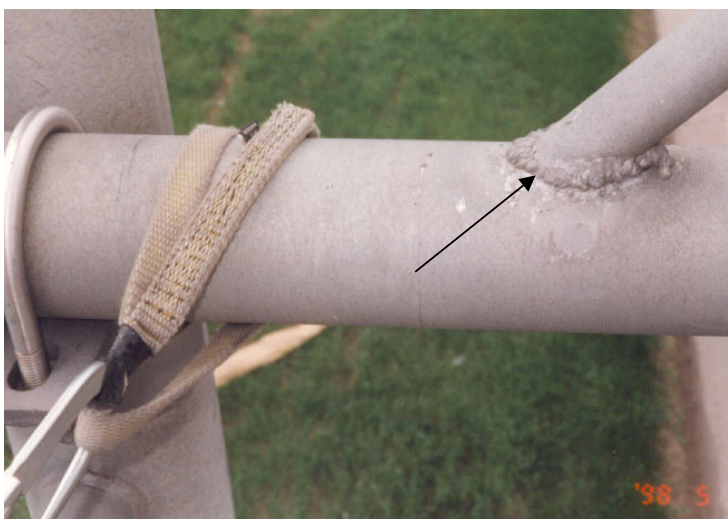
Évaluation du comportement des assemblages soudés
